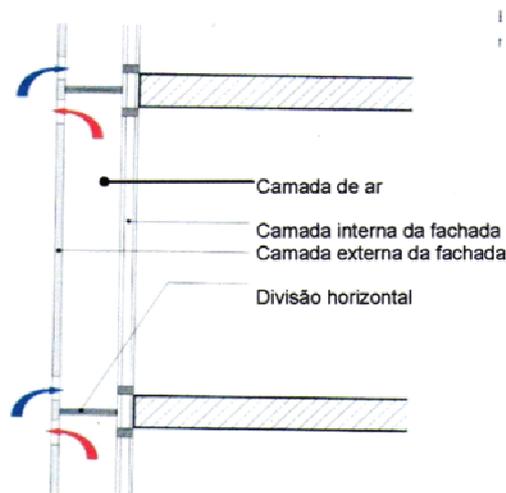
Corte esquemático de uma fachada dupla ventilada
